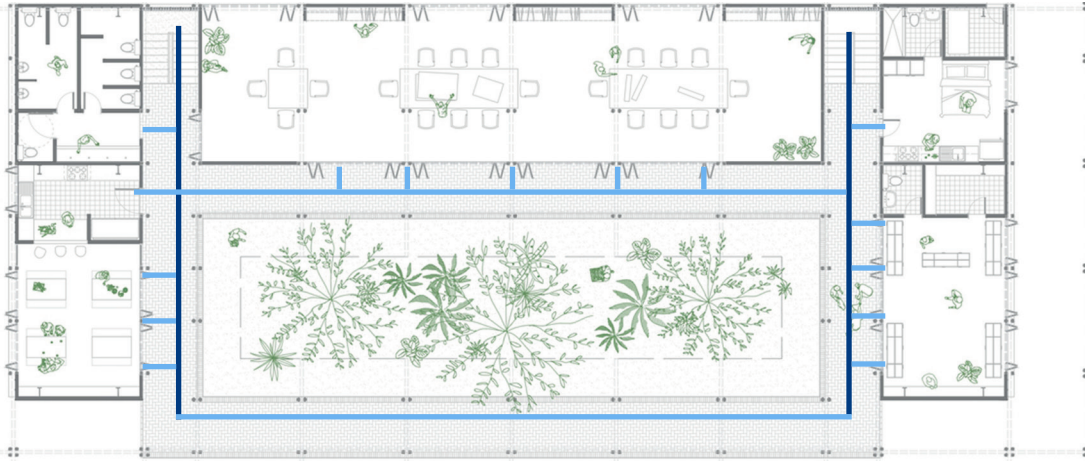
"Las Tejedoras" – Planta baja – Circulación
